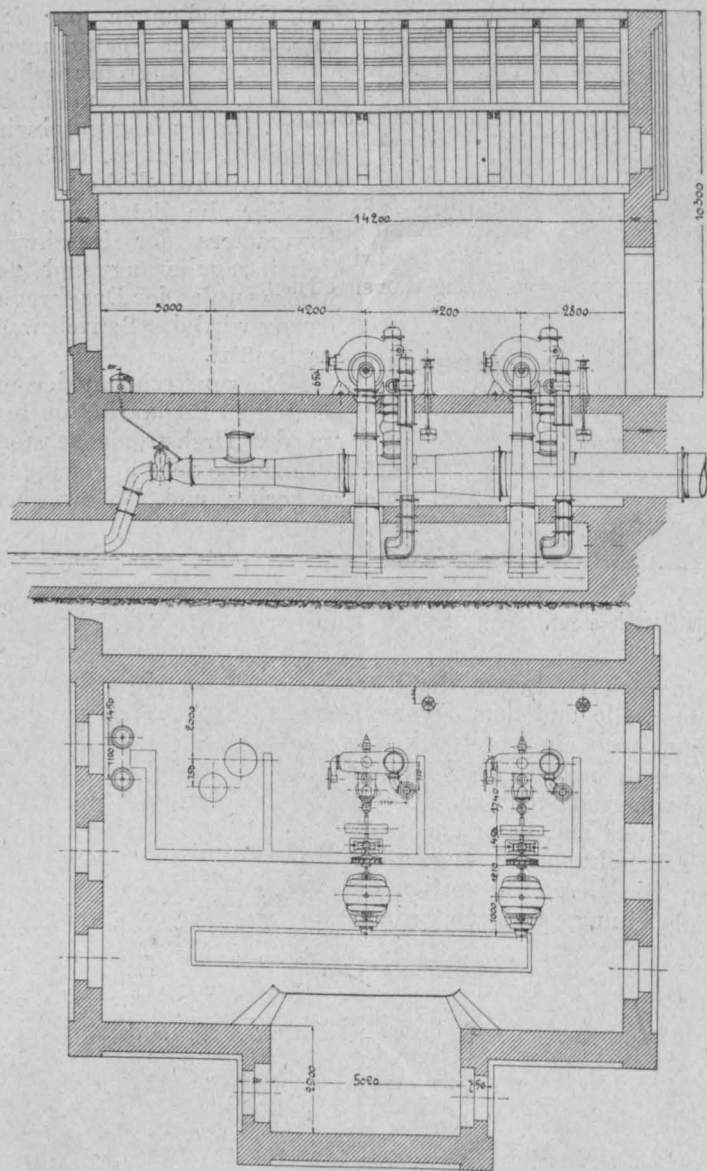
bis 11. Grundriß und Schnitte des Maschinenhauses.
